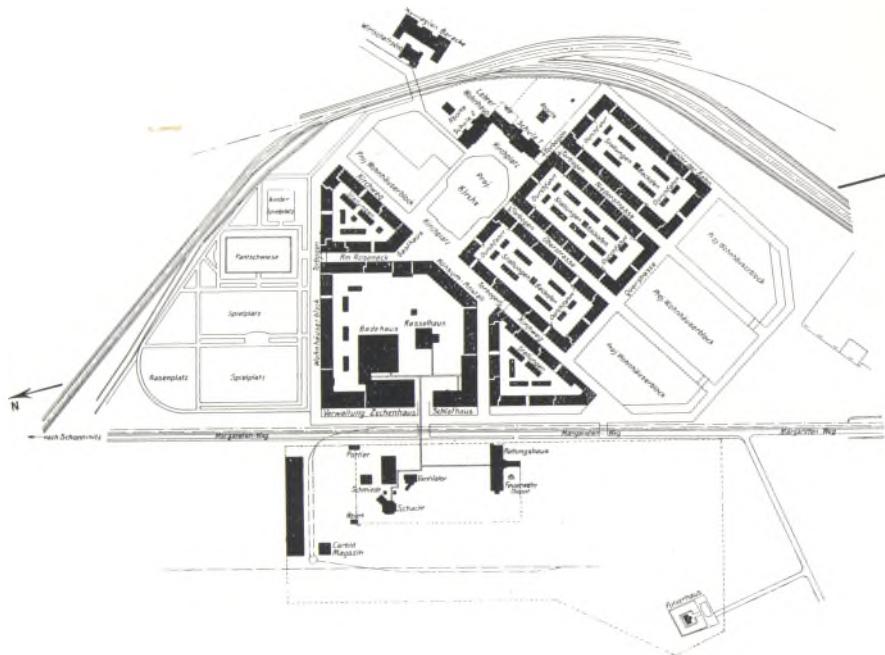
Kolonie Nickischschacht. Lageplan. Maßstab ungefähr 1 : 12 000.
